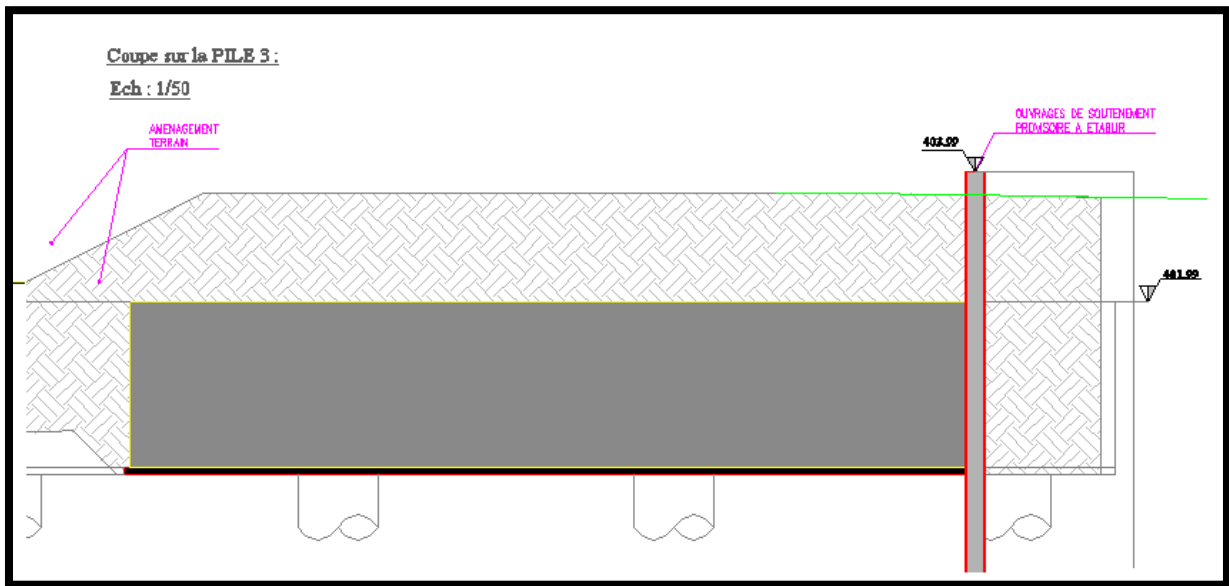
Coupe sur la pile 3 avec l'ouvrage de soutènement
